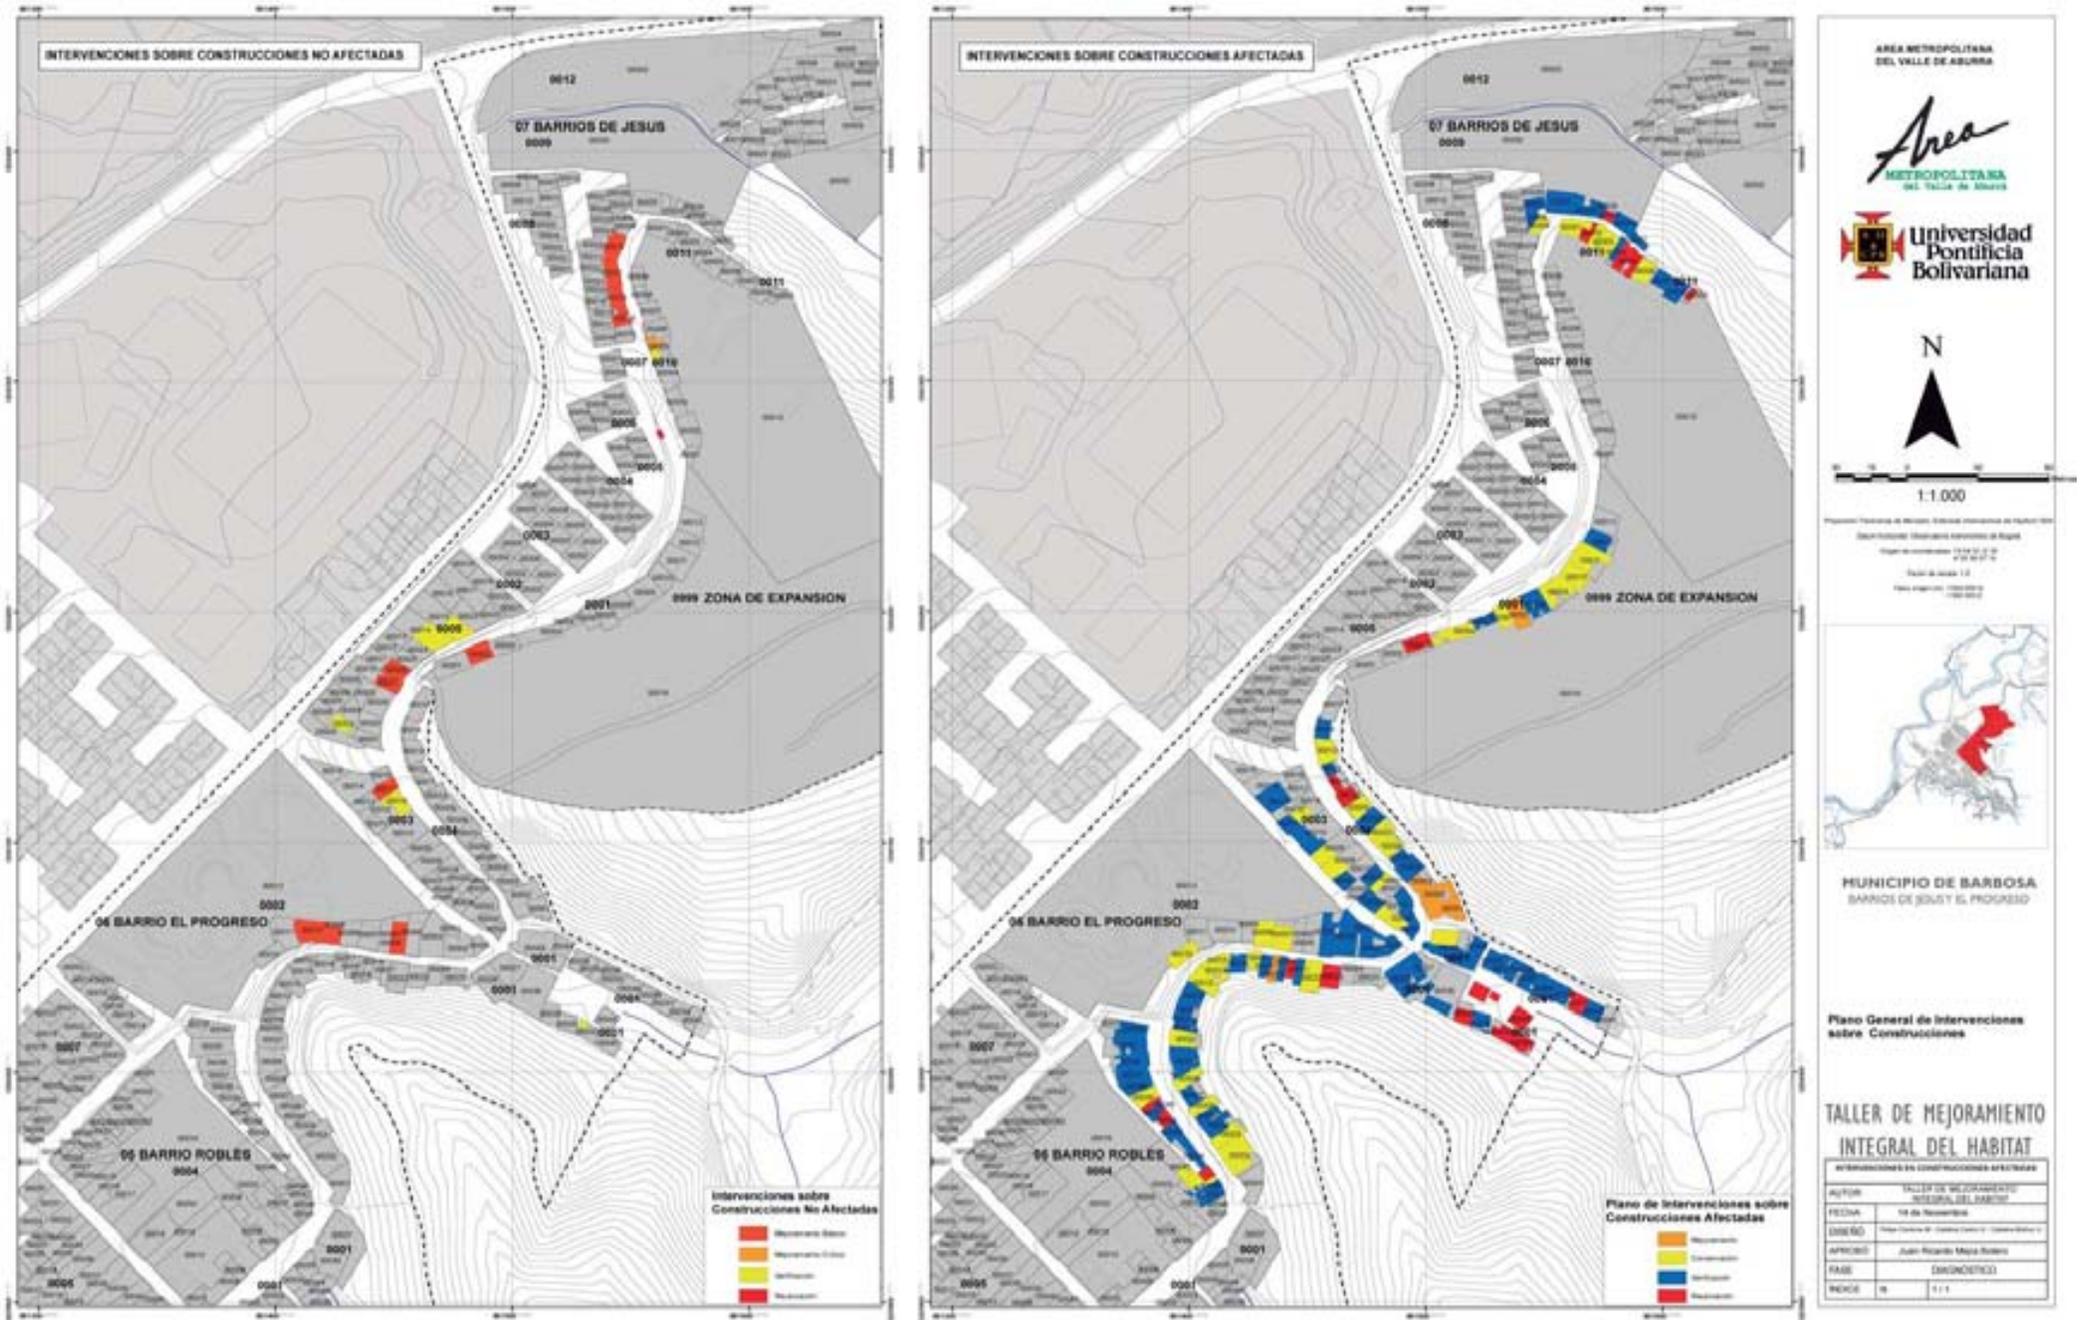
Plano general de las acciones o intervenciones que se van a realizar sobre las construcciones inventariadas
